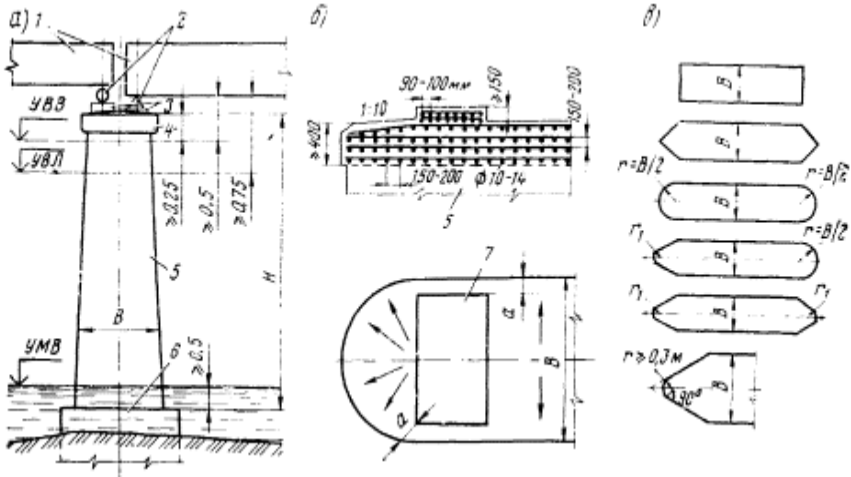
Основные элементы опор: 1 - пролетные строения; 2 - опорные части; 3 - подферменники; 4 - оголовки опоры; 5 - тело опоры; 6 - обрез фундамента; 7 - подферменная площадка
